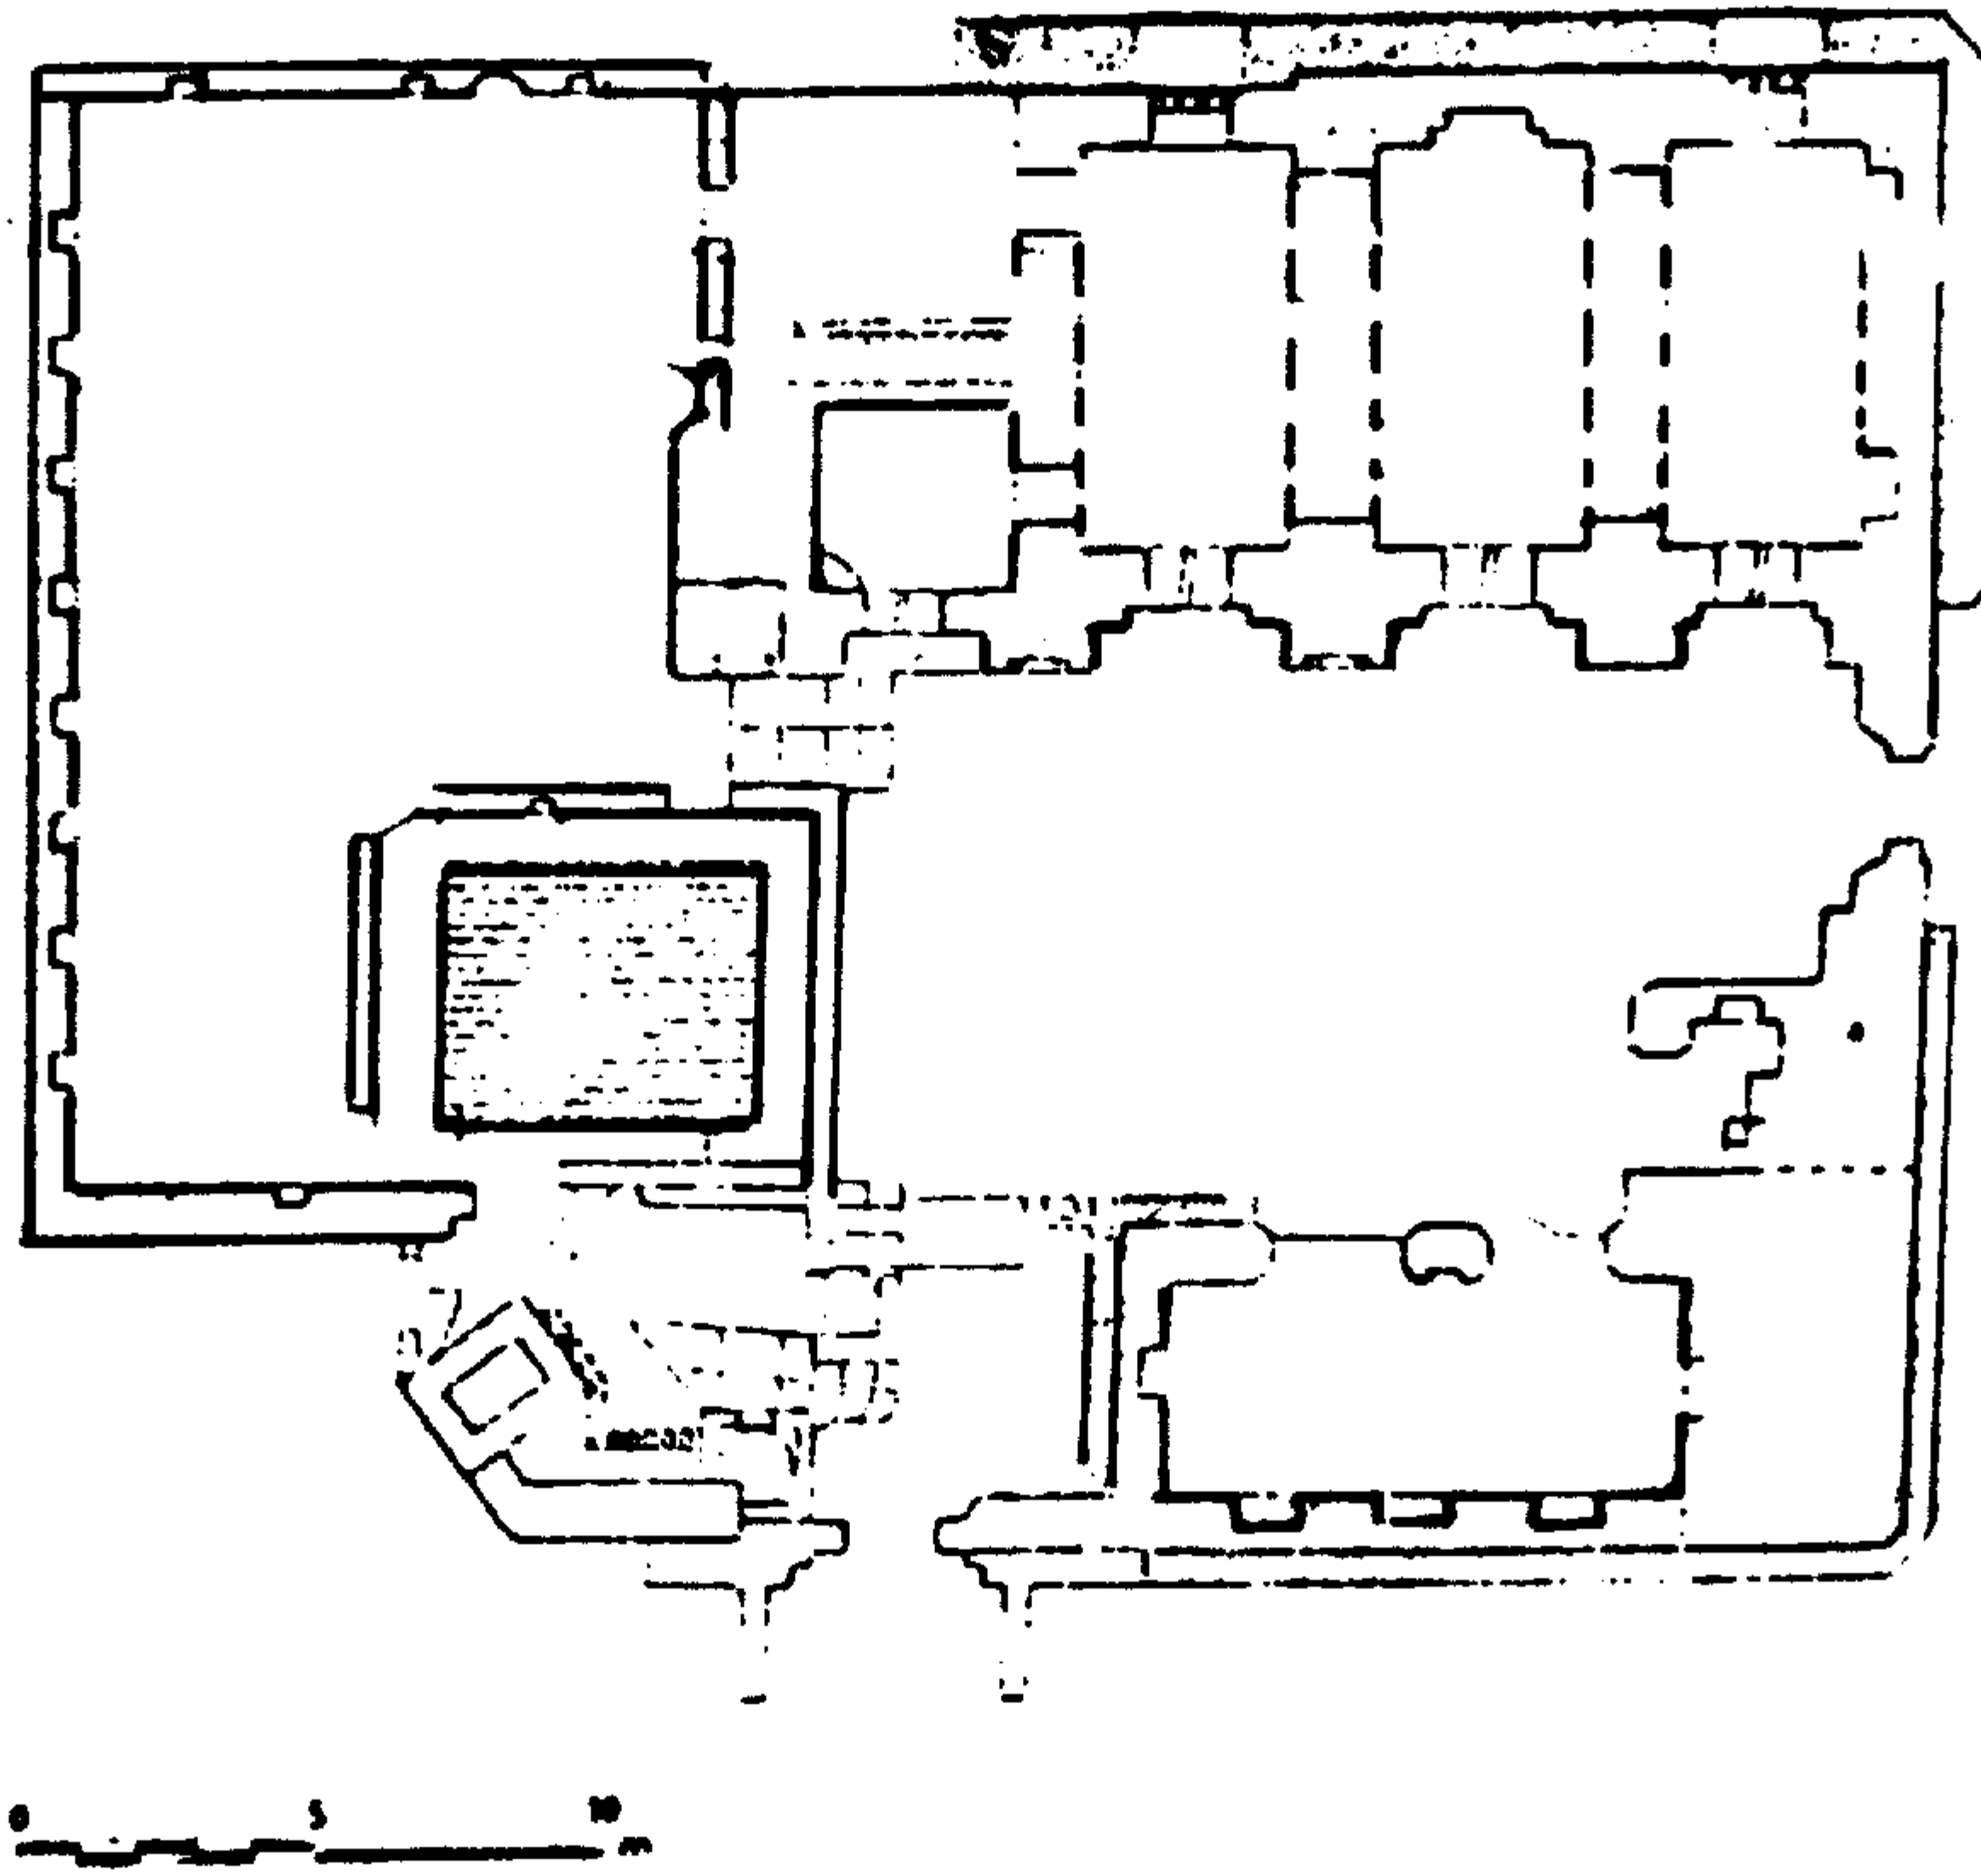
مسقط أفقي للمدرسة الوهابية بزبيد.
